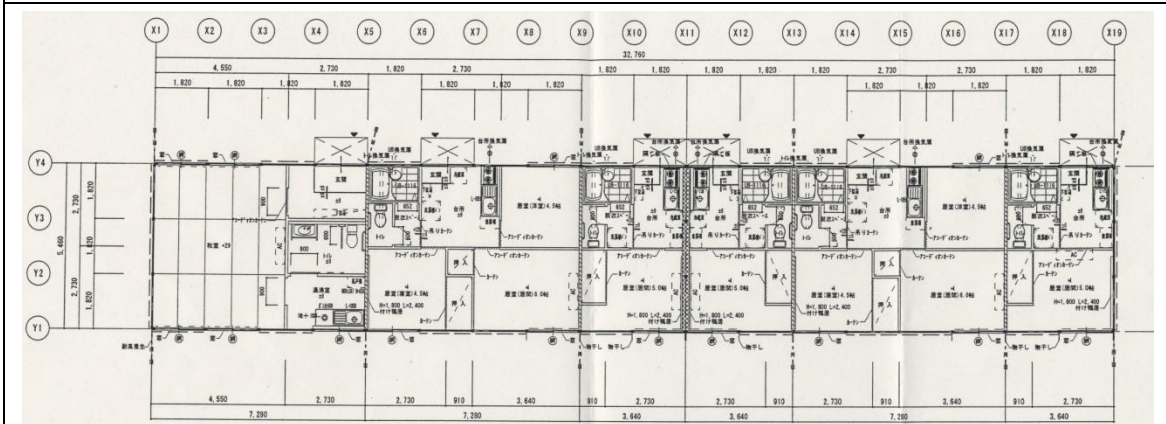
織笠仮設団地 仮設住宅平面図②
